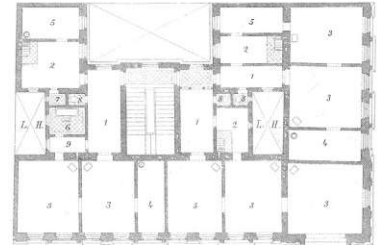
Grundriss 1. und 2. Stockwerk, Langegasse 18 - Gebrüder Drexler, 1892
